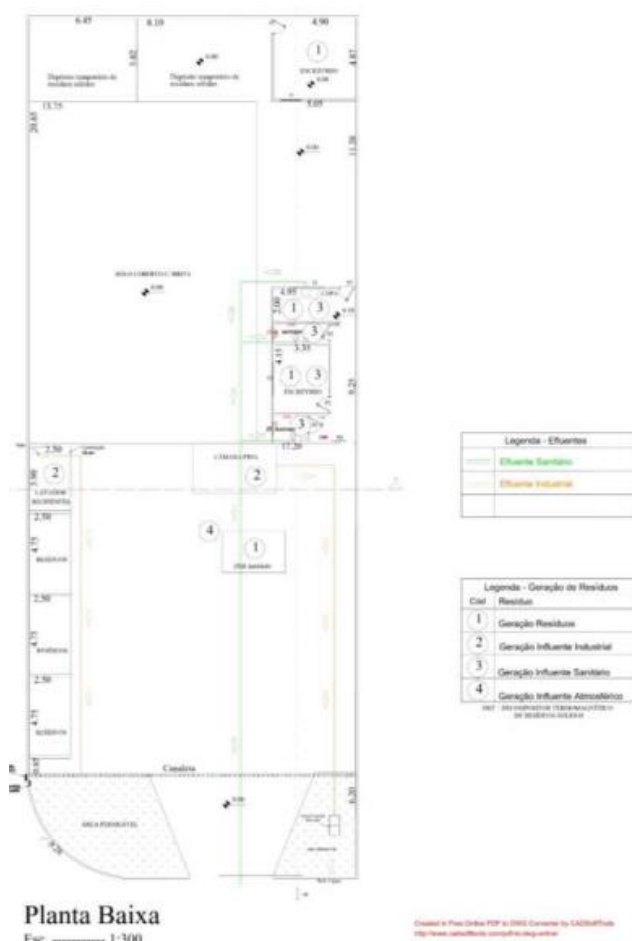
Planta Baixa / Gruntec Serviços Ambientais. Fonte: RCA
